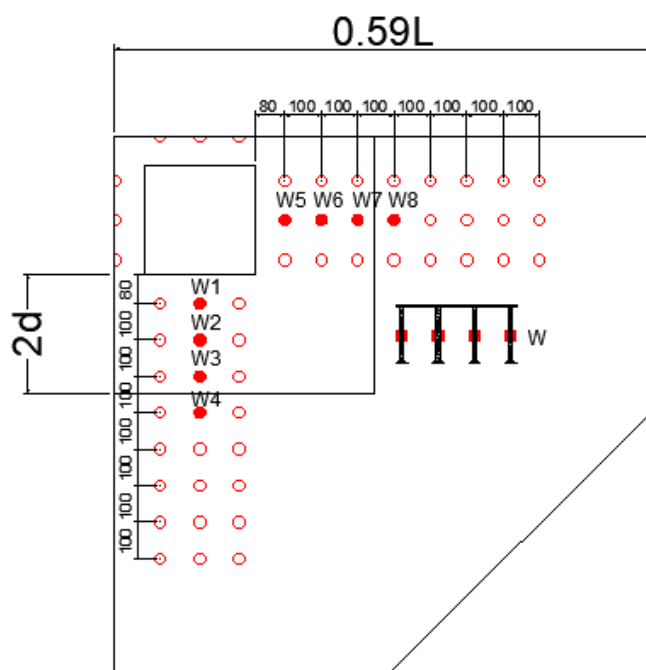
Extensômetros de cisalhamento das Lajes SS0 e SS100 (Autora, 2023).
